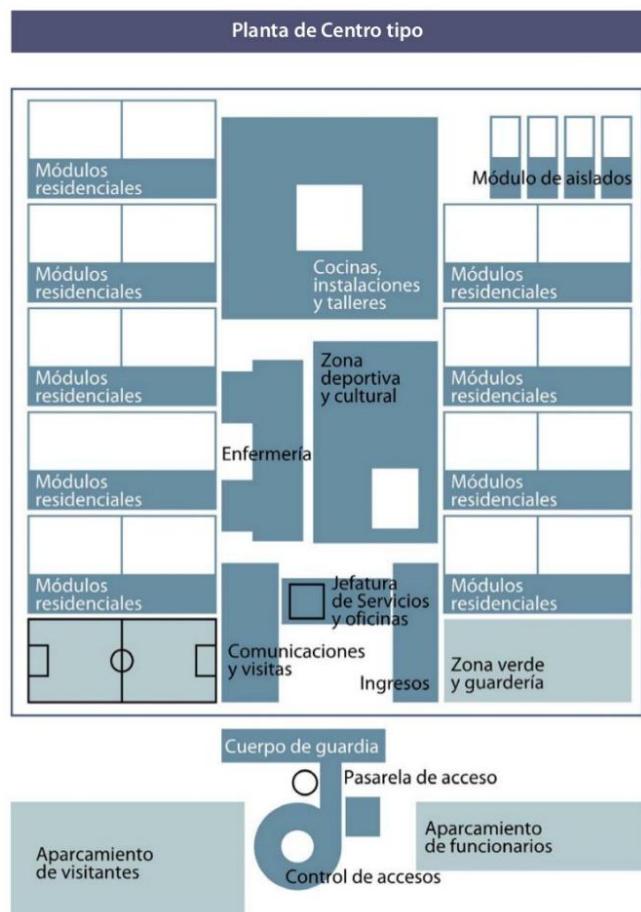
Planta de Centro Tipo. Fuente: Ministerio del Interior (2010)
